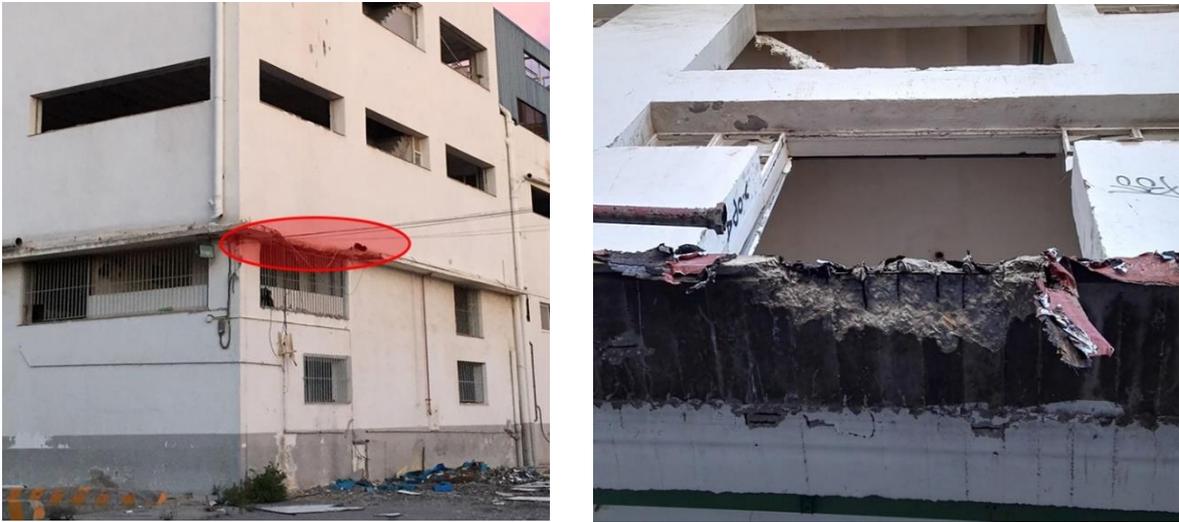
Imagen izquierda. Derrumbe de la marquesina en la fachada suroeste de la nave I. Imagen derecha. Desprendimientos en marquesina (fachada sureste de la nave I. Fuente: autora.
